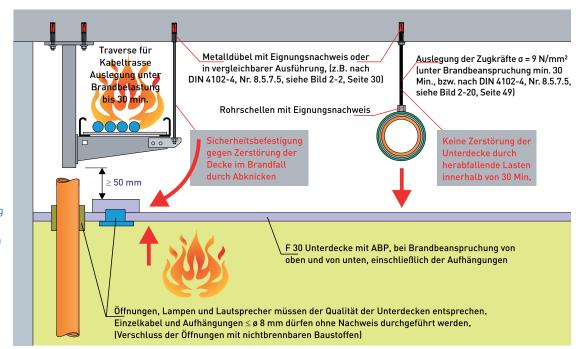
Befestigung von Leitungsanlagen oberhalb von F 30 Unterdecken
